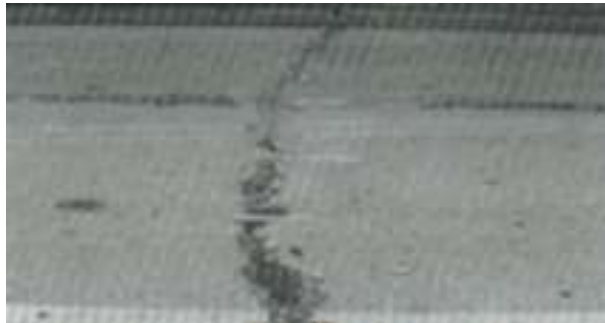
Grietas Lineales de Alta Severidad en Losa de Concreto Simple.
